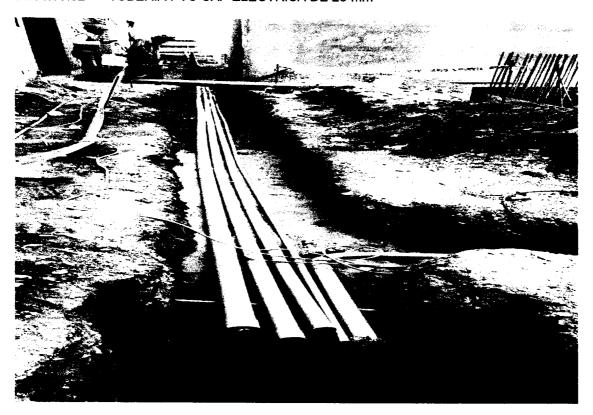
Tubería de PVC eléctrico de 25 mm en redes
